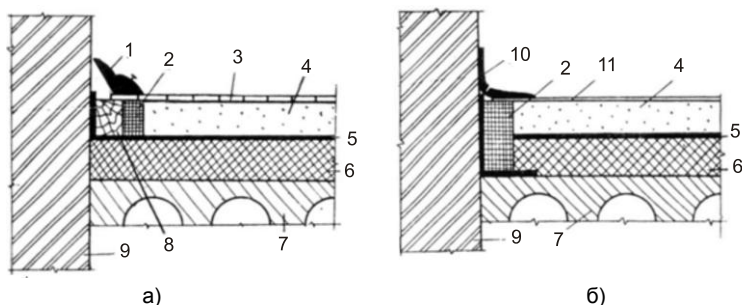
Конструкция пола с самонивелирующейся стяжкой по слою теплоизоляции:
